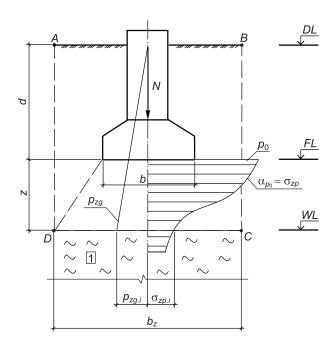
Расчетная схема для проверки прочности слабого подстилающего слоя грунта
